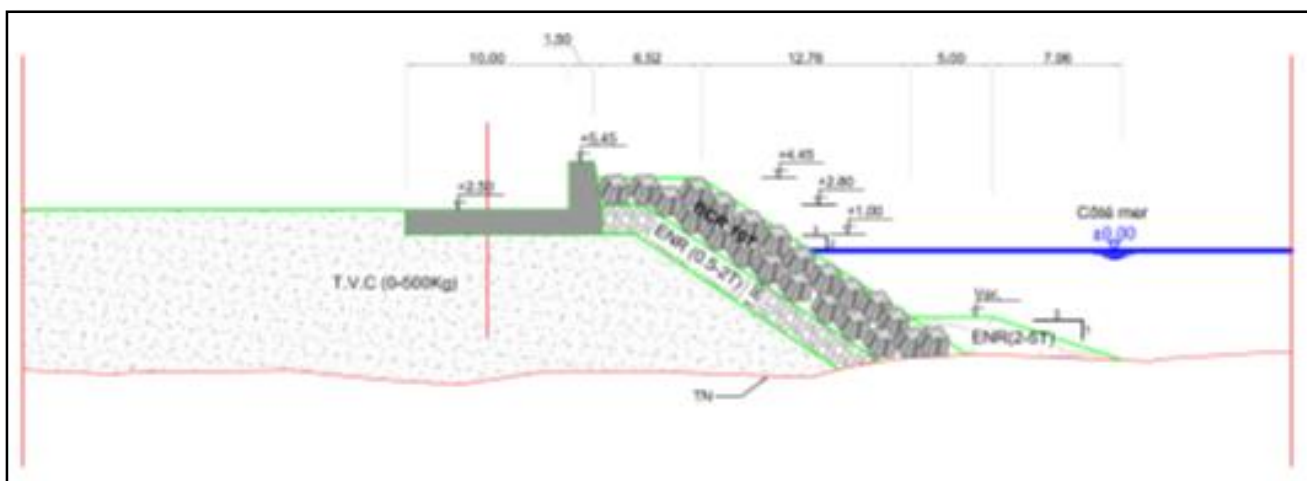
Variante 02 – jetée principale- profil enracinement
